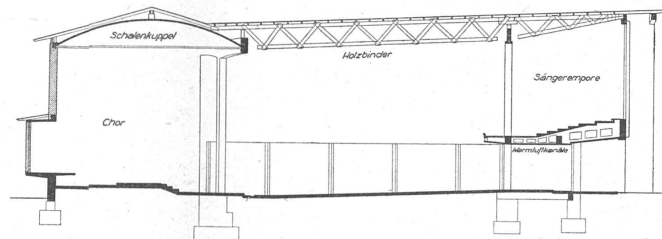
Längsschnitt 1:300 durch Gebäudeachse | Coupe longitudinale dans l'axe du bâtiment | Longitudinal section
